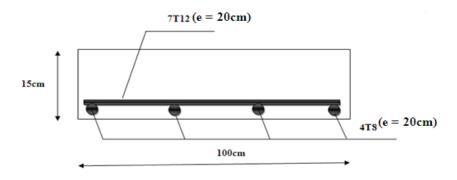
Schéma de ferraillage de l'escalier en travée.
